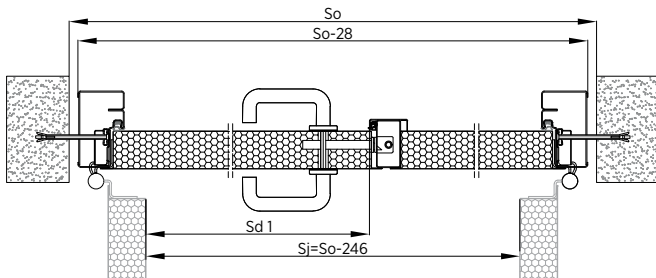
Pose au mur – bloc-porte à deux vantaux – bâti intérieur à rupture de pont thermique – coupe horizontale
